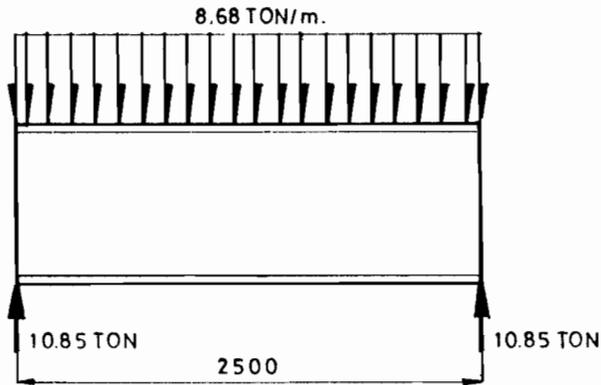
FUERZAS SOBRE LAS VIGAS LONGITUDINALES.
